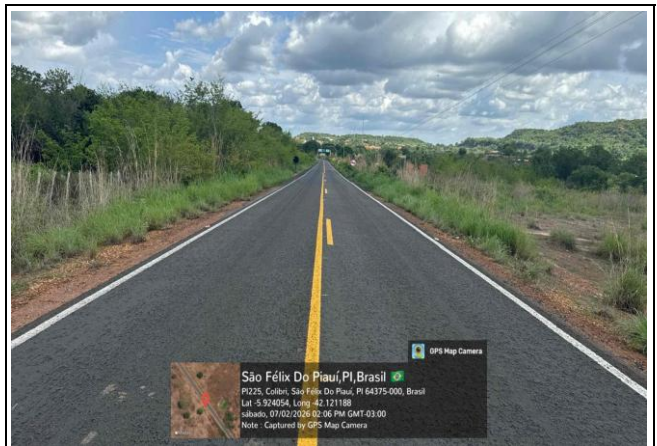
LOCAL PARA CONSTRUÇÃO DO PORTAL DE ENTRADA
